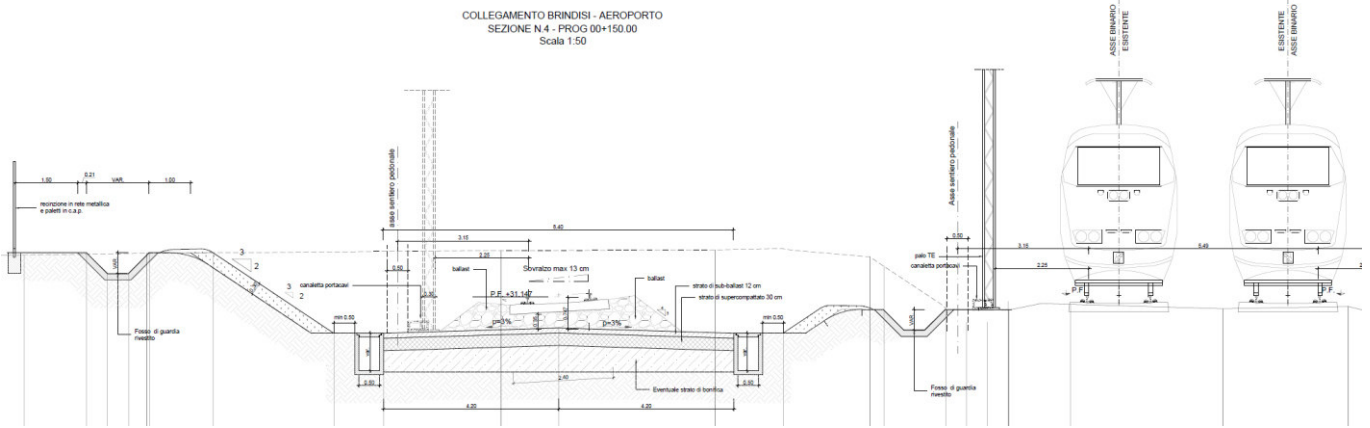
Sezione tipo stretto affiancamento Linea Aeroporto
